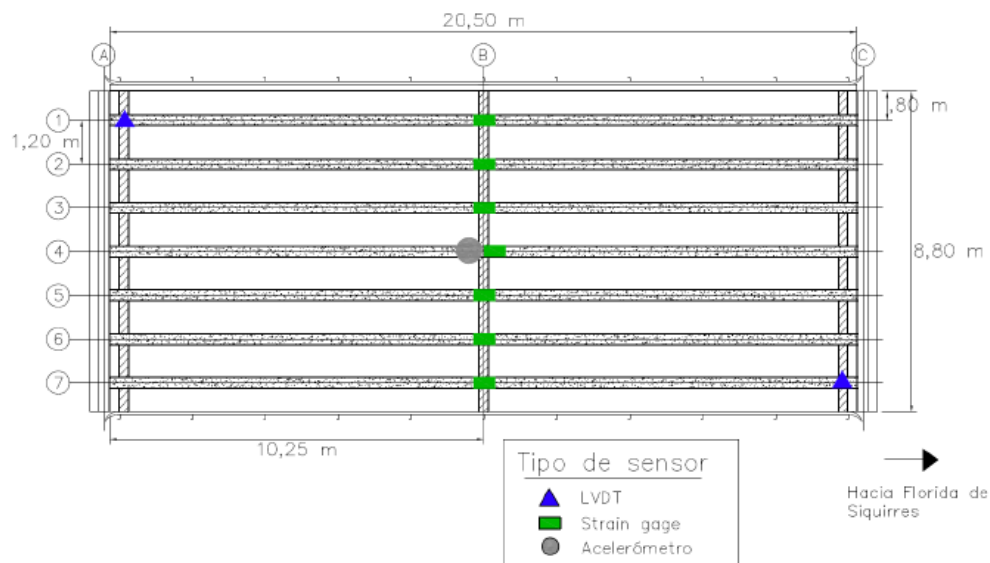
Configuración de la instrumentación en el puente sobre el Río Peje.
